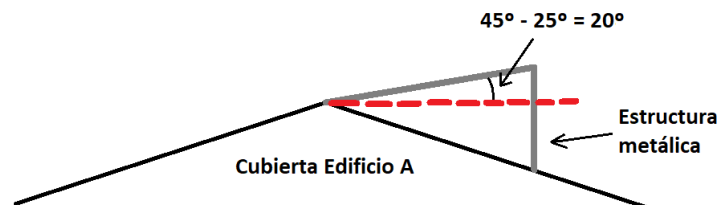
Inclinación de los paneles sobre estructura triangular metálica.
